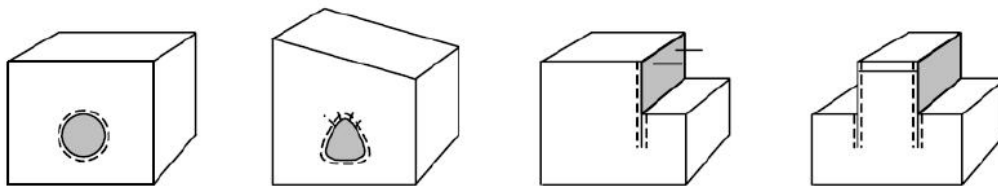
Exemplos de aplicação de Plates em túneis e estruturas apoiadas e ancoradas (Manual Plaxis).
